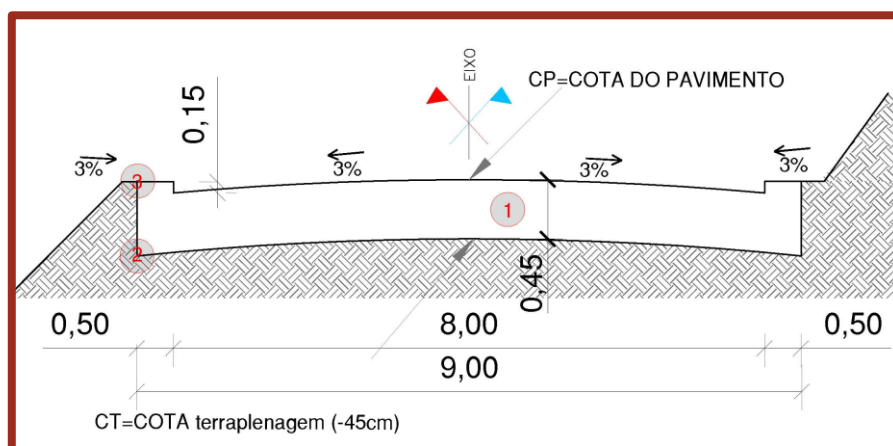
Demonstração do cálculo volumes da Caixa de pavimento
